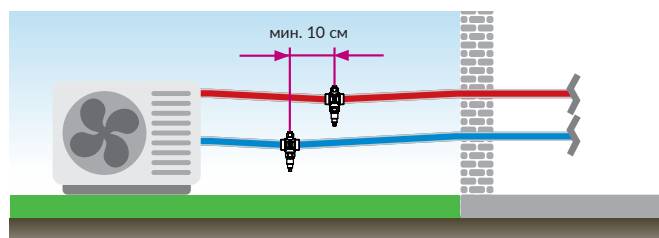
Допустимое монтажное положение клапанов без накладок и прокладка труб в системе
